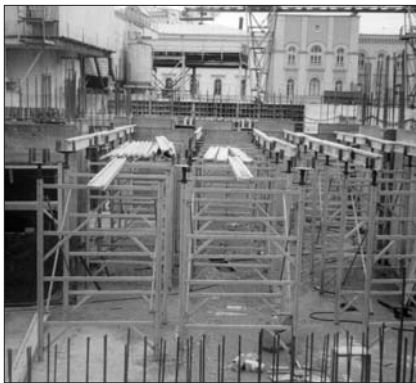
Алюминиевые конструкции опалубки перекрытий
